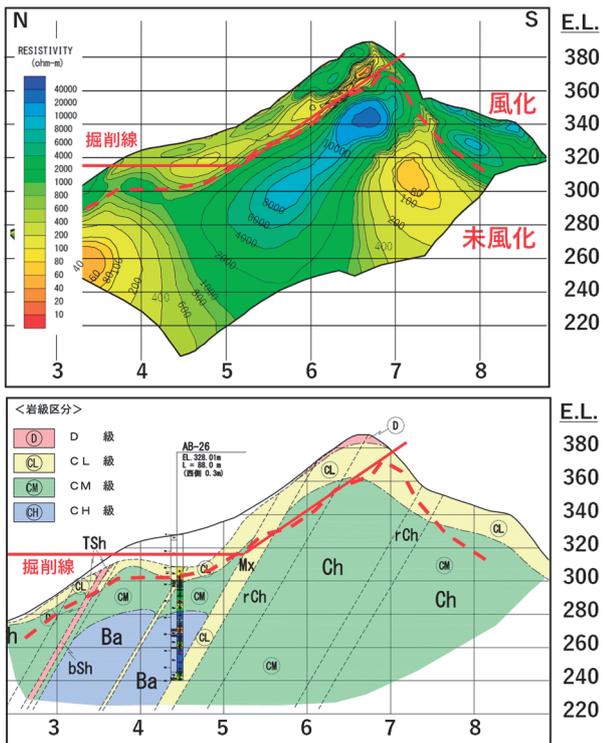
探査結果断面図 (上) および当初想定岩級区分断面図 (下)
